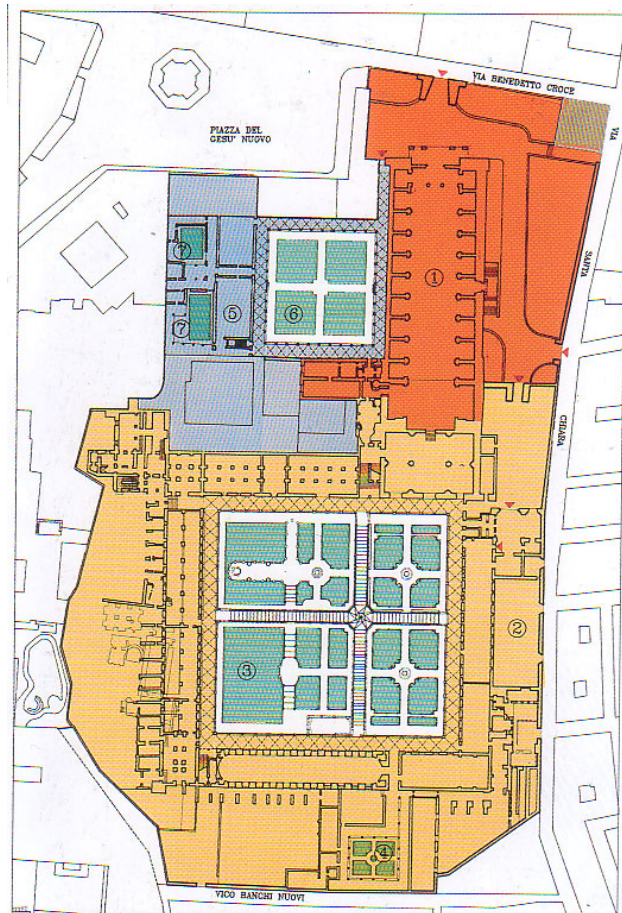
Neapel, S. Chiara, Kirche und Kloster, Grundriss
